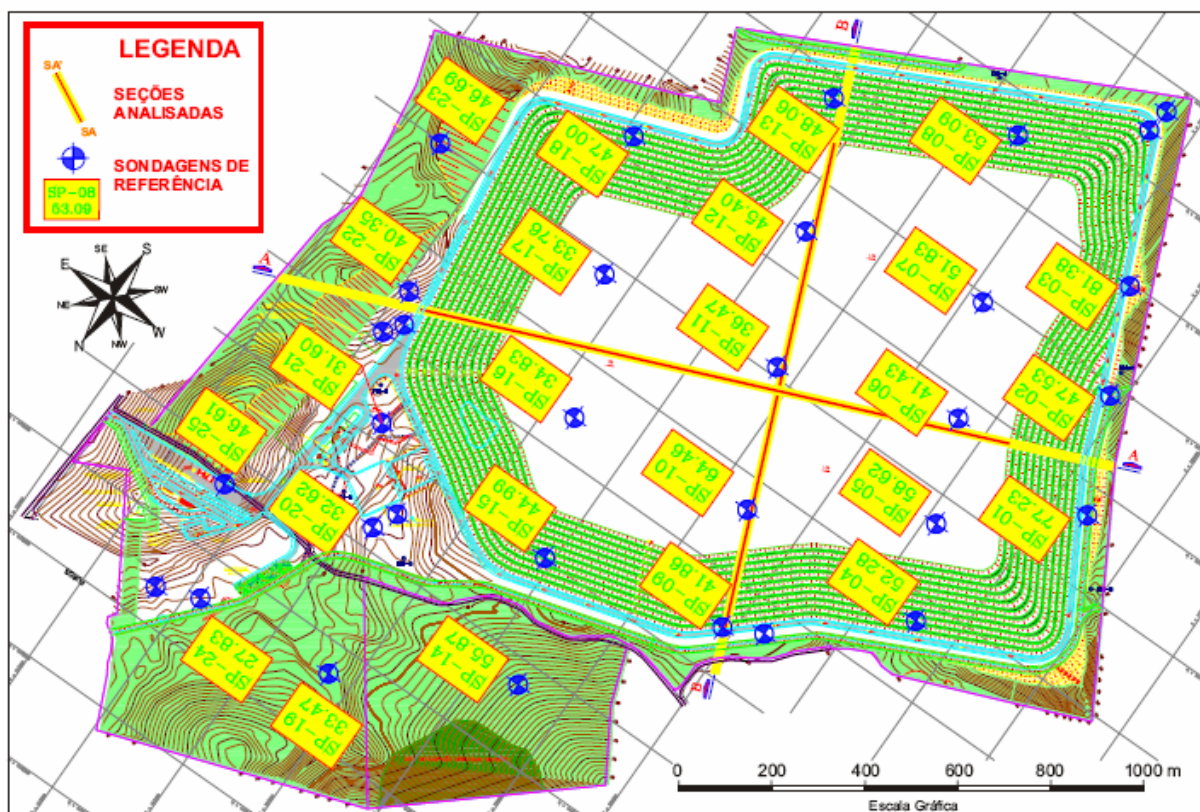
Planta do aterro sanitário concluído com seções SA' e SB' e sondagens
